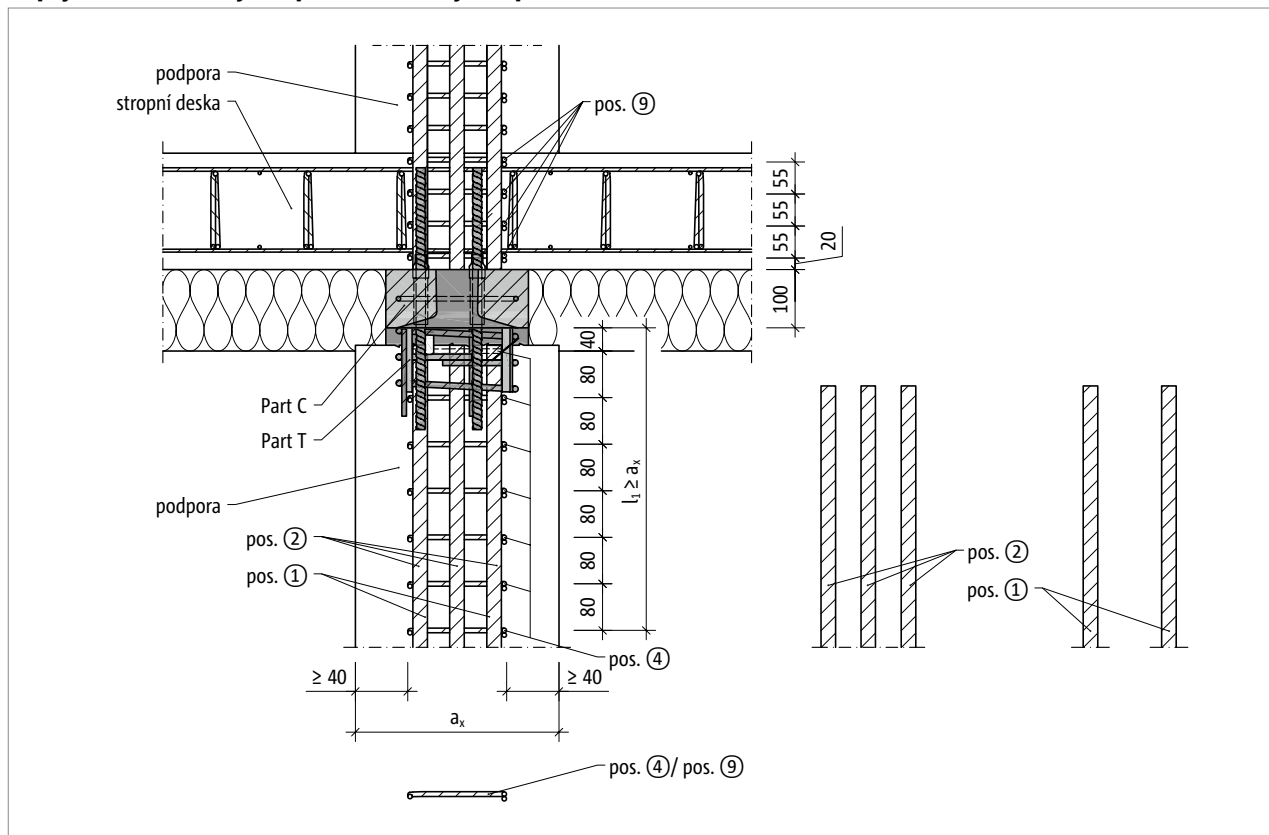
Schöck Scconnex® typ P: Napojovací stavební výztuž v podélném průřezu sloupu A-A
